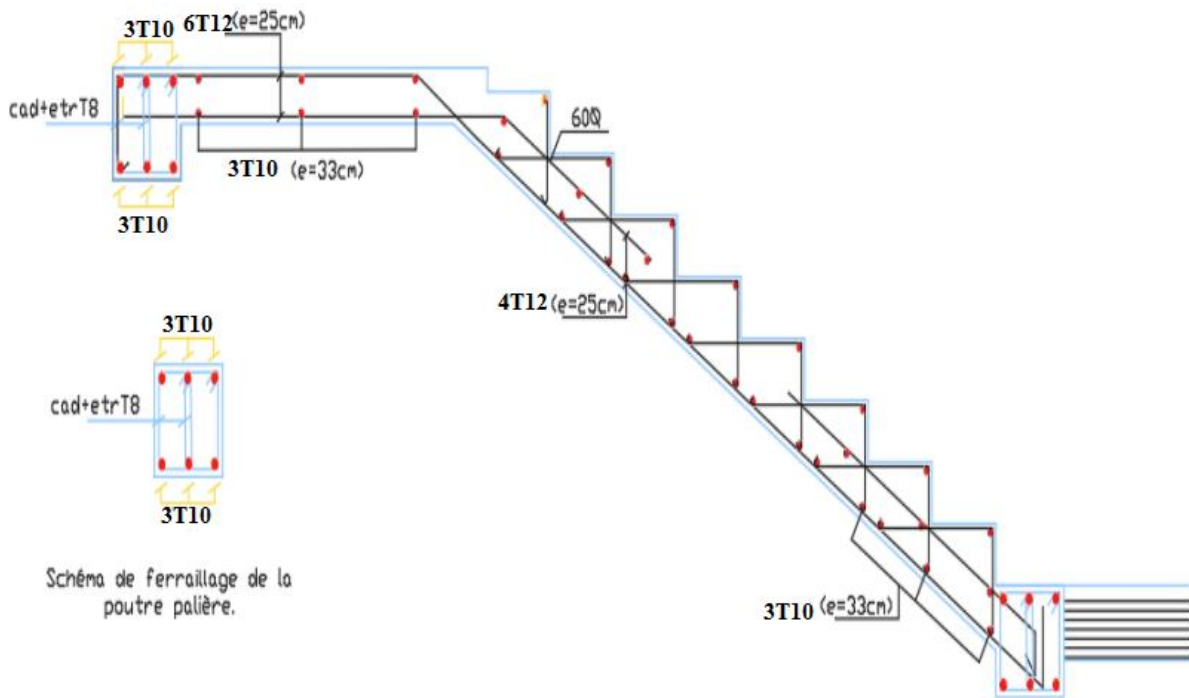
schéma de ferrillage d'escalier et de la poutre palière.
